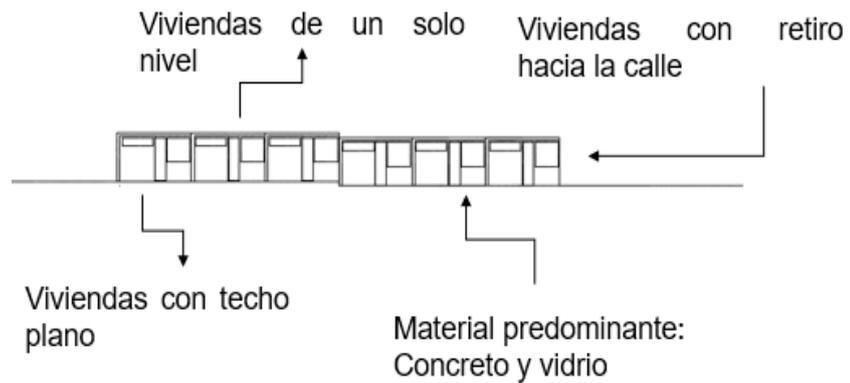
Edificación existente en el Perfil calle J. de la Rosa
